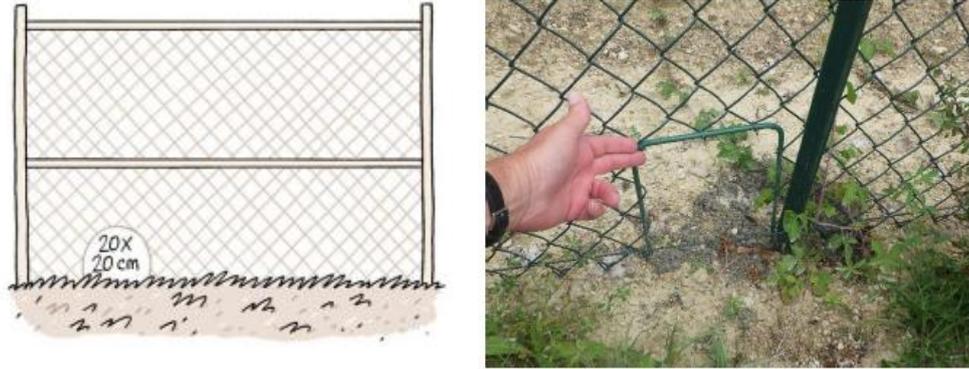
EXEMPLE DE CLOTURES AVEC PASSAGE A FAUNE (SOURCE SCHEMA : BRUXELLES ENVIRONNEMENT, SOURCE PHOTO : ARTIFEX)
